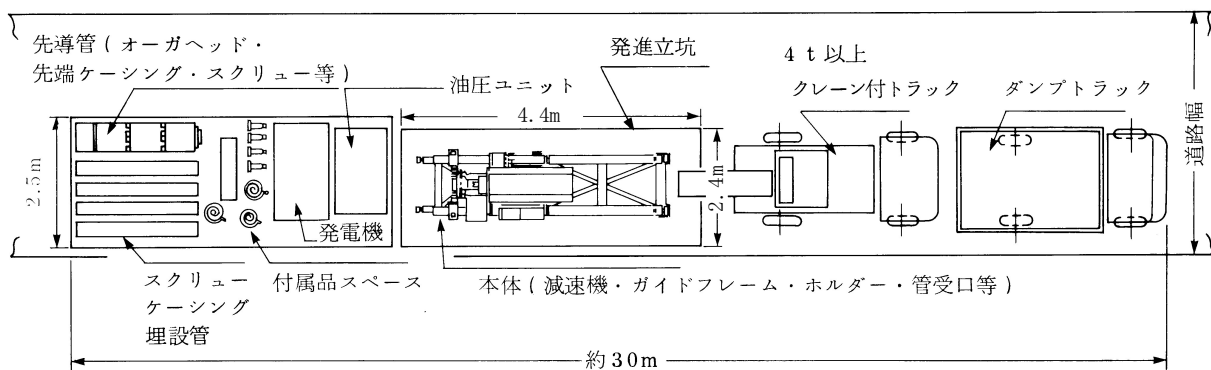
矩形 4.4m×2.4m 立坑用推進機 全体配置例
